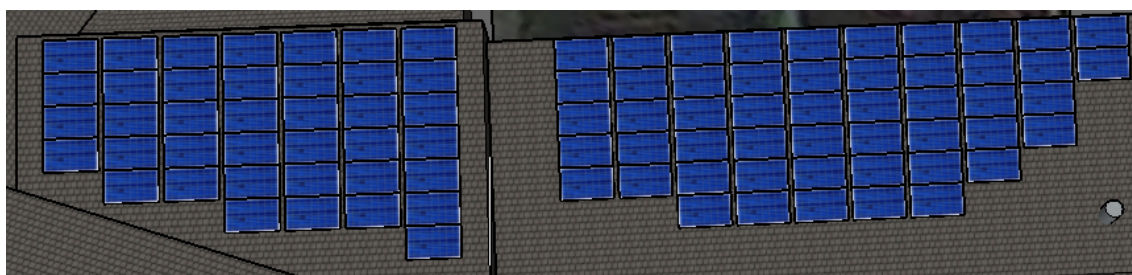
Instalação dos painéis no telhado 13 e 14.
